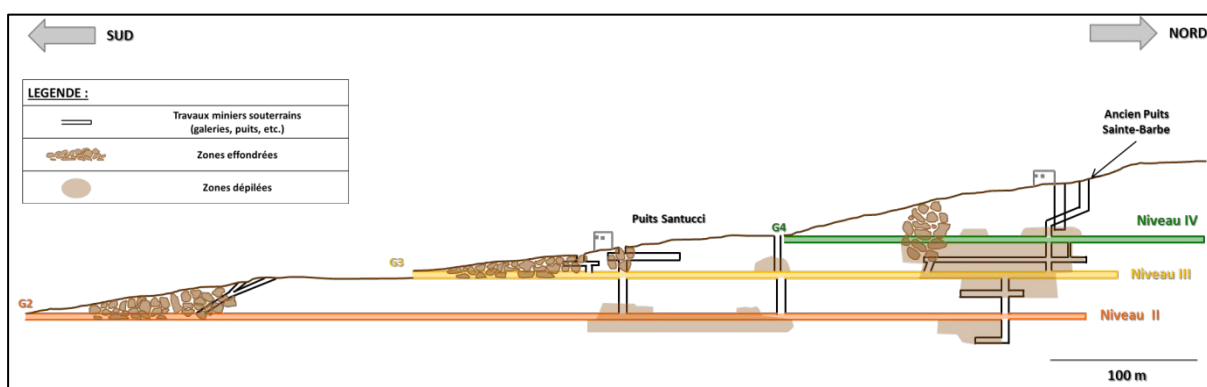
Schéma des travaux miniers souterrains et zones effondrées principales
